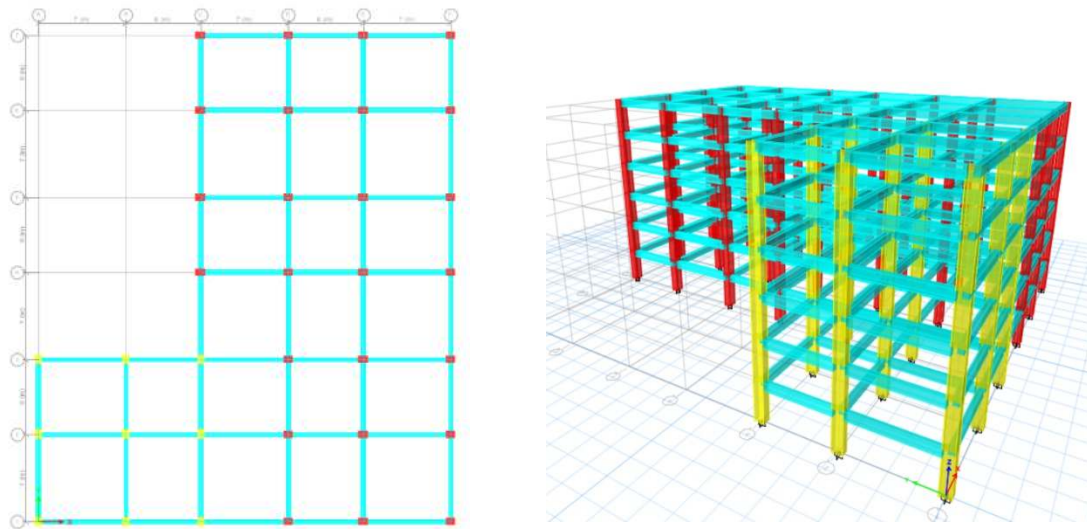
Edificio de 6 pisos irregular con Columnas y vigas con vista en planta y 3D.
